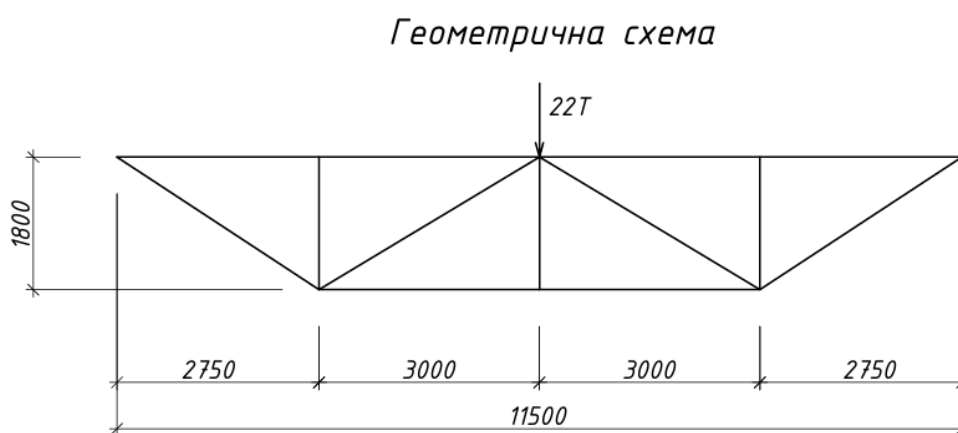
Геометрична схема навантажень на підкроквяну ферму
